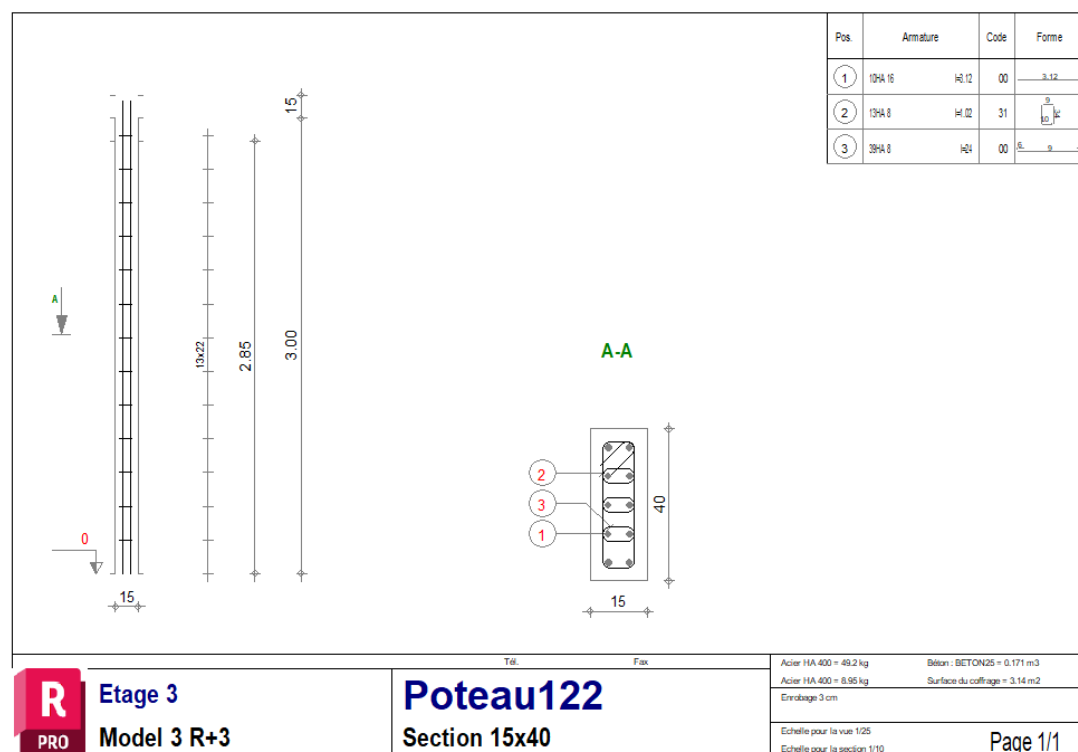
Plan de ferrailage du poteau les plus charge après renforcement.
